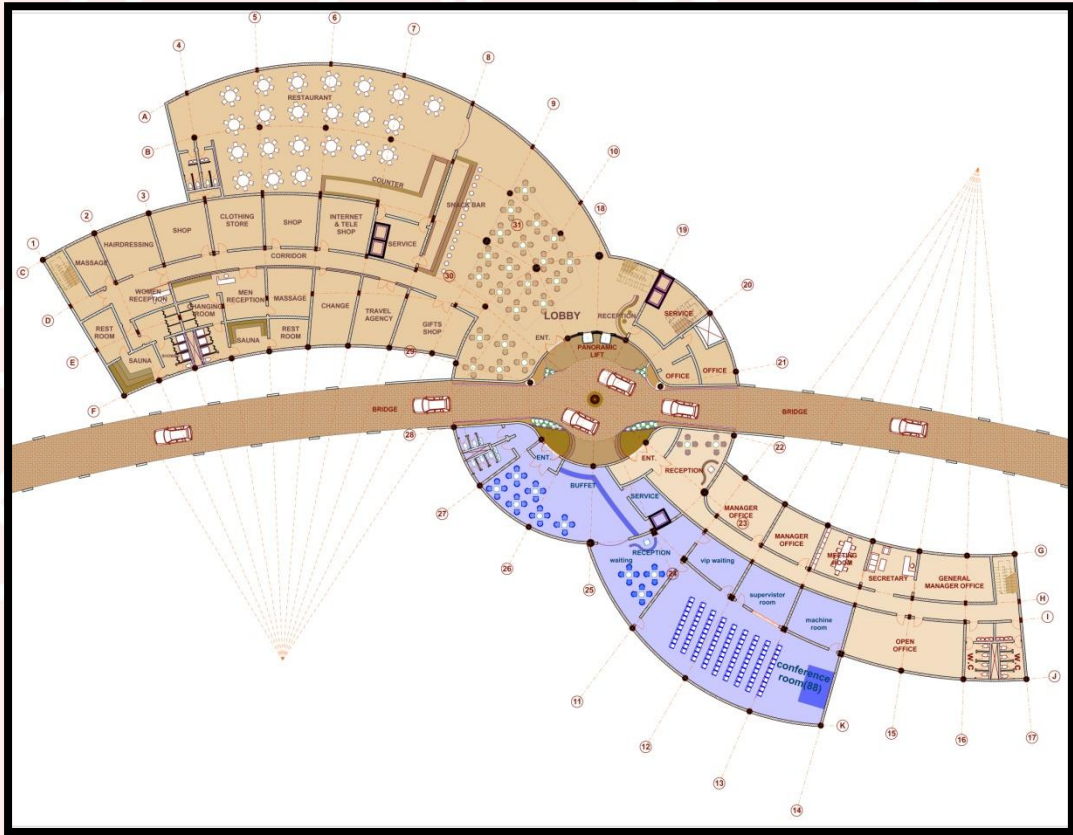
المسقط الأفقي للطابق الأرضي للفندق
